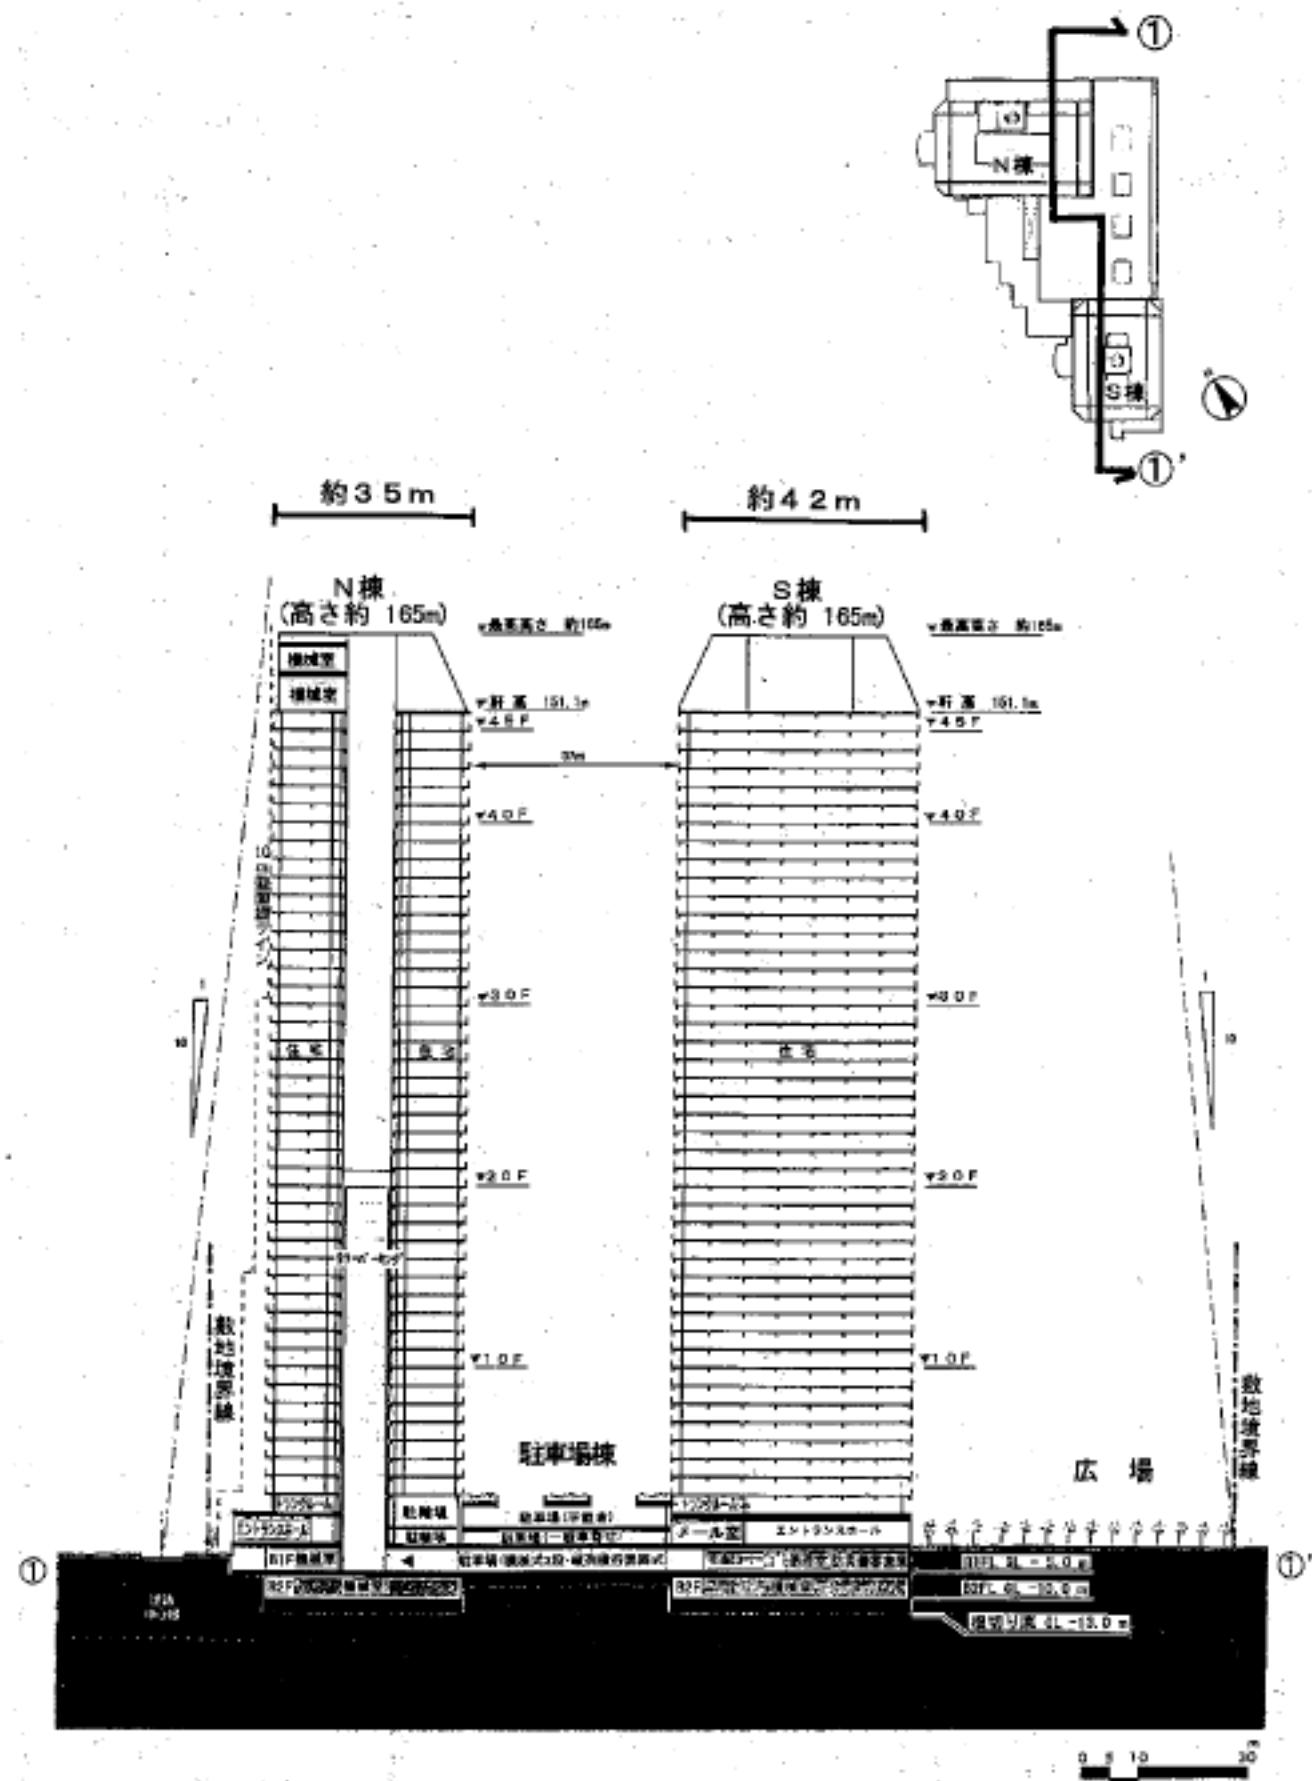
(1) 計画建築物断面図 (①-①'断面)
